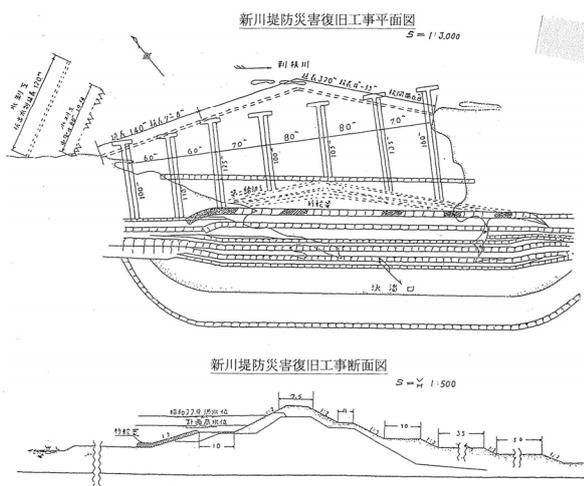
新川堤防災害復旧工事平面図及び断面図（カスリーン台風から40年, 1987）
